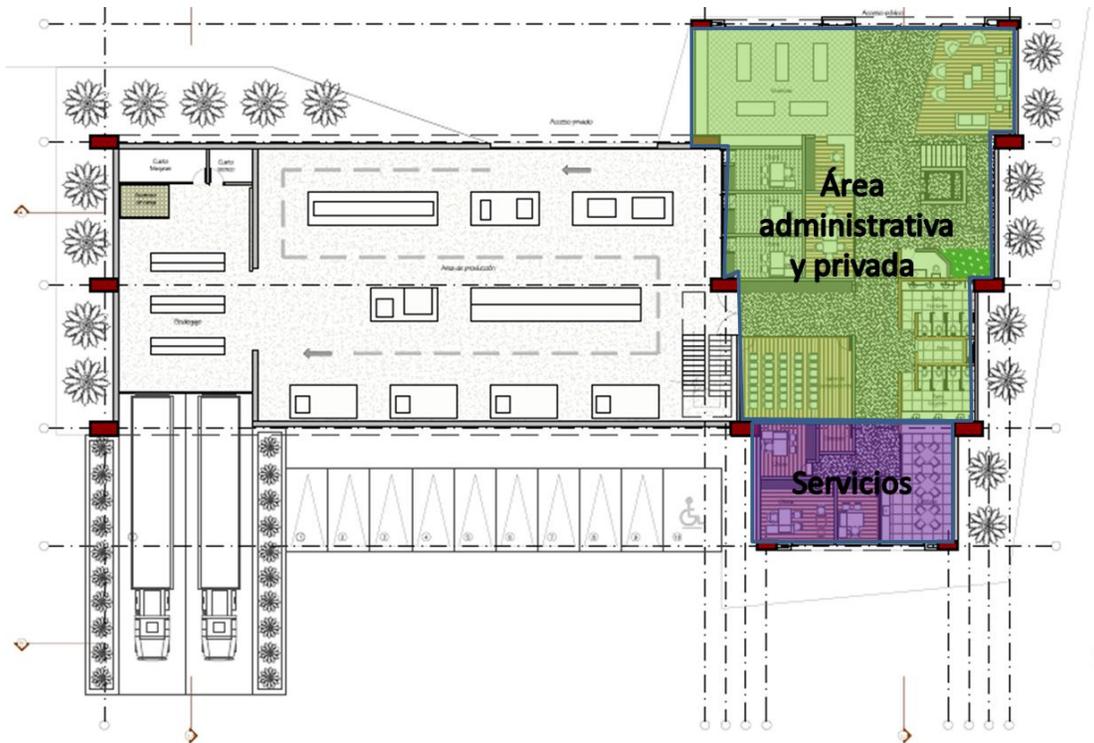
Zonificación en primera planta (Fuente: elaboración propia)
